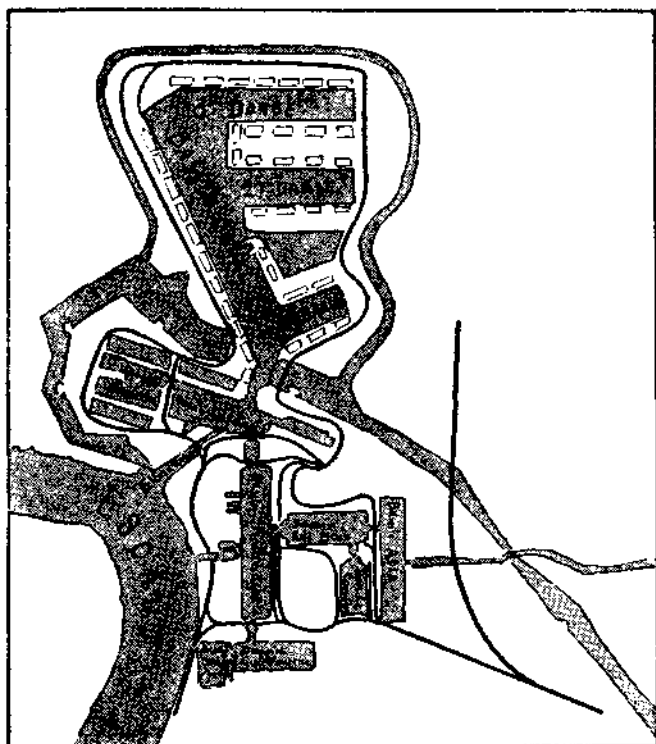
PLAN DES TRAVAUX EXÉCUTÉS EN 1914.
